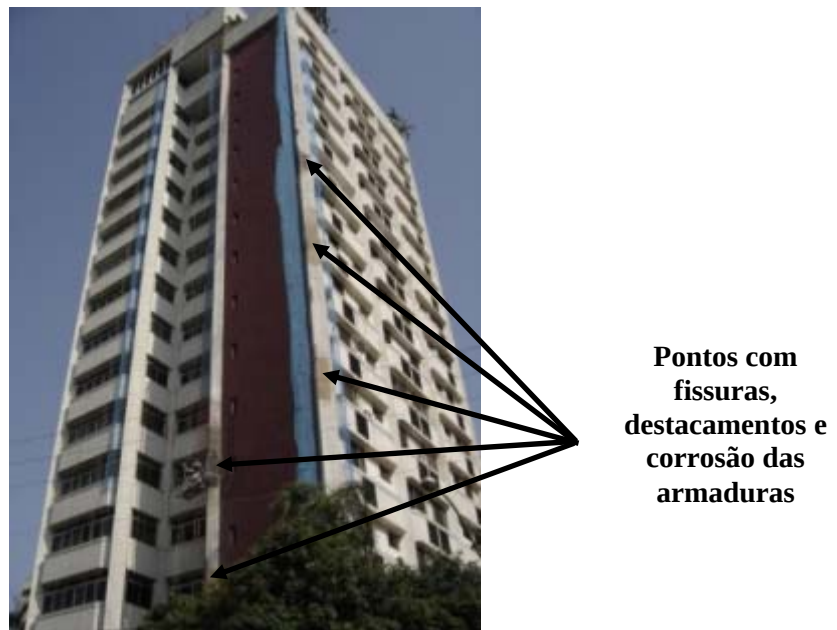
Trechos com destacamentos do revestimento devido à corrosão das armaduras nas posições de fissuras do edifício 2
